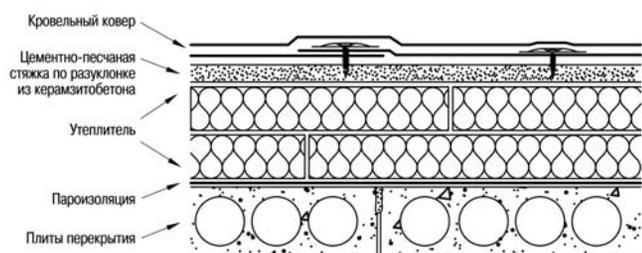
Механическое крепление кровельных материалов к основанию из железобетона
